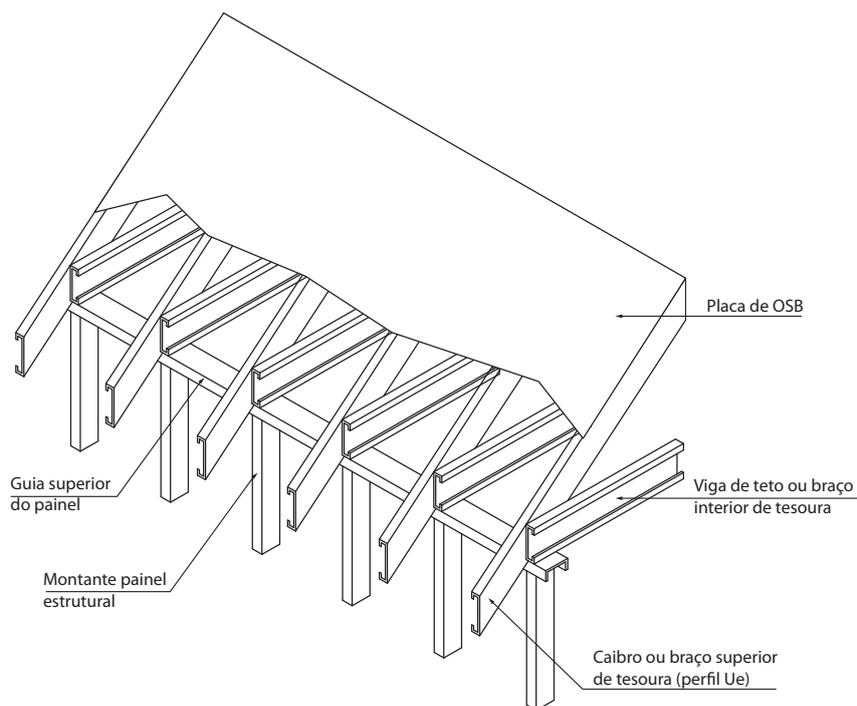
Caibros e vigas alinhados com montantes de painel estrutural
